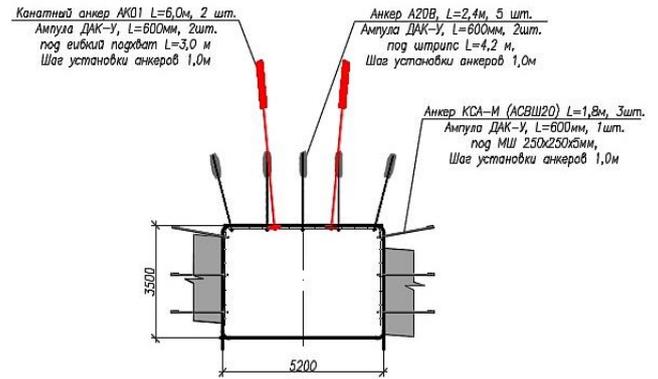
Схема крепления вентиляционного штрека шахты «Увальная»
